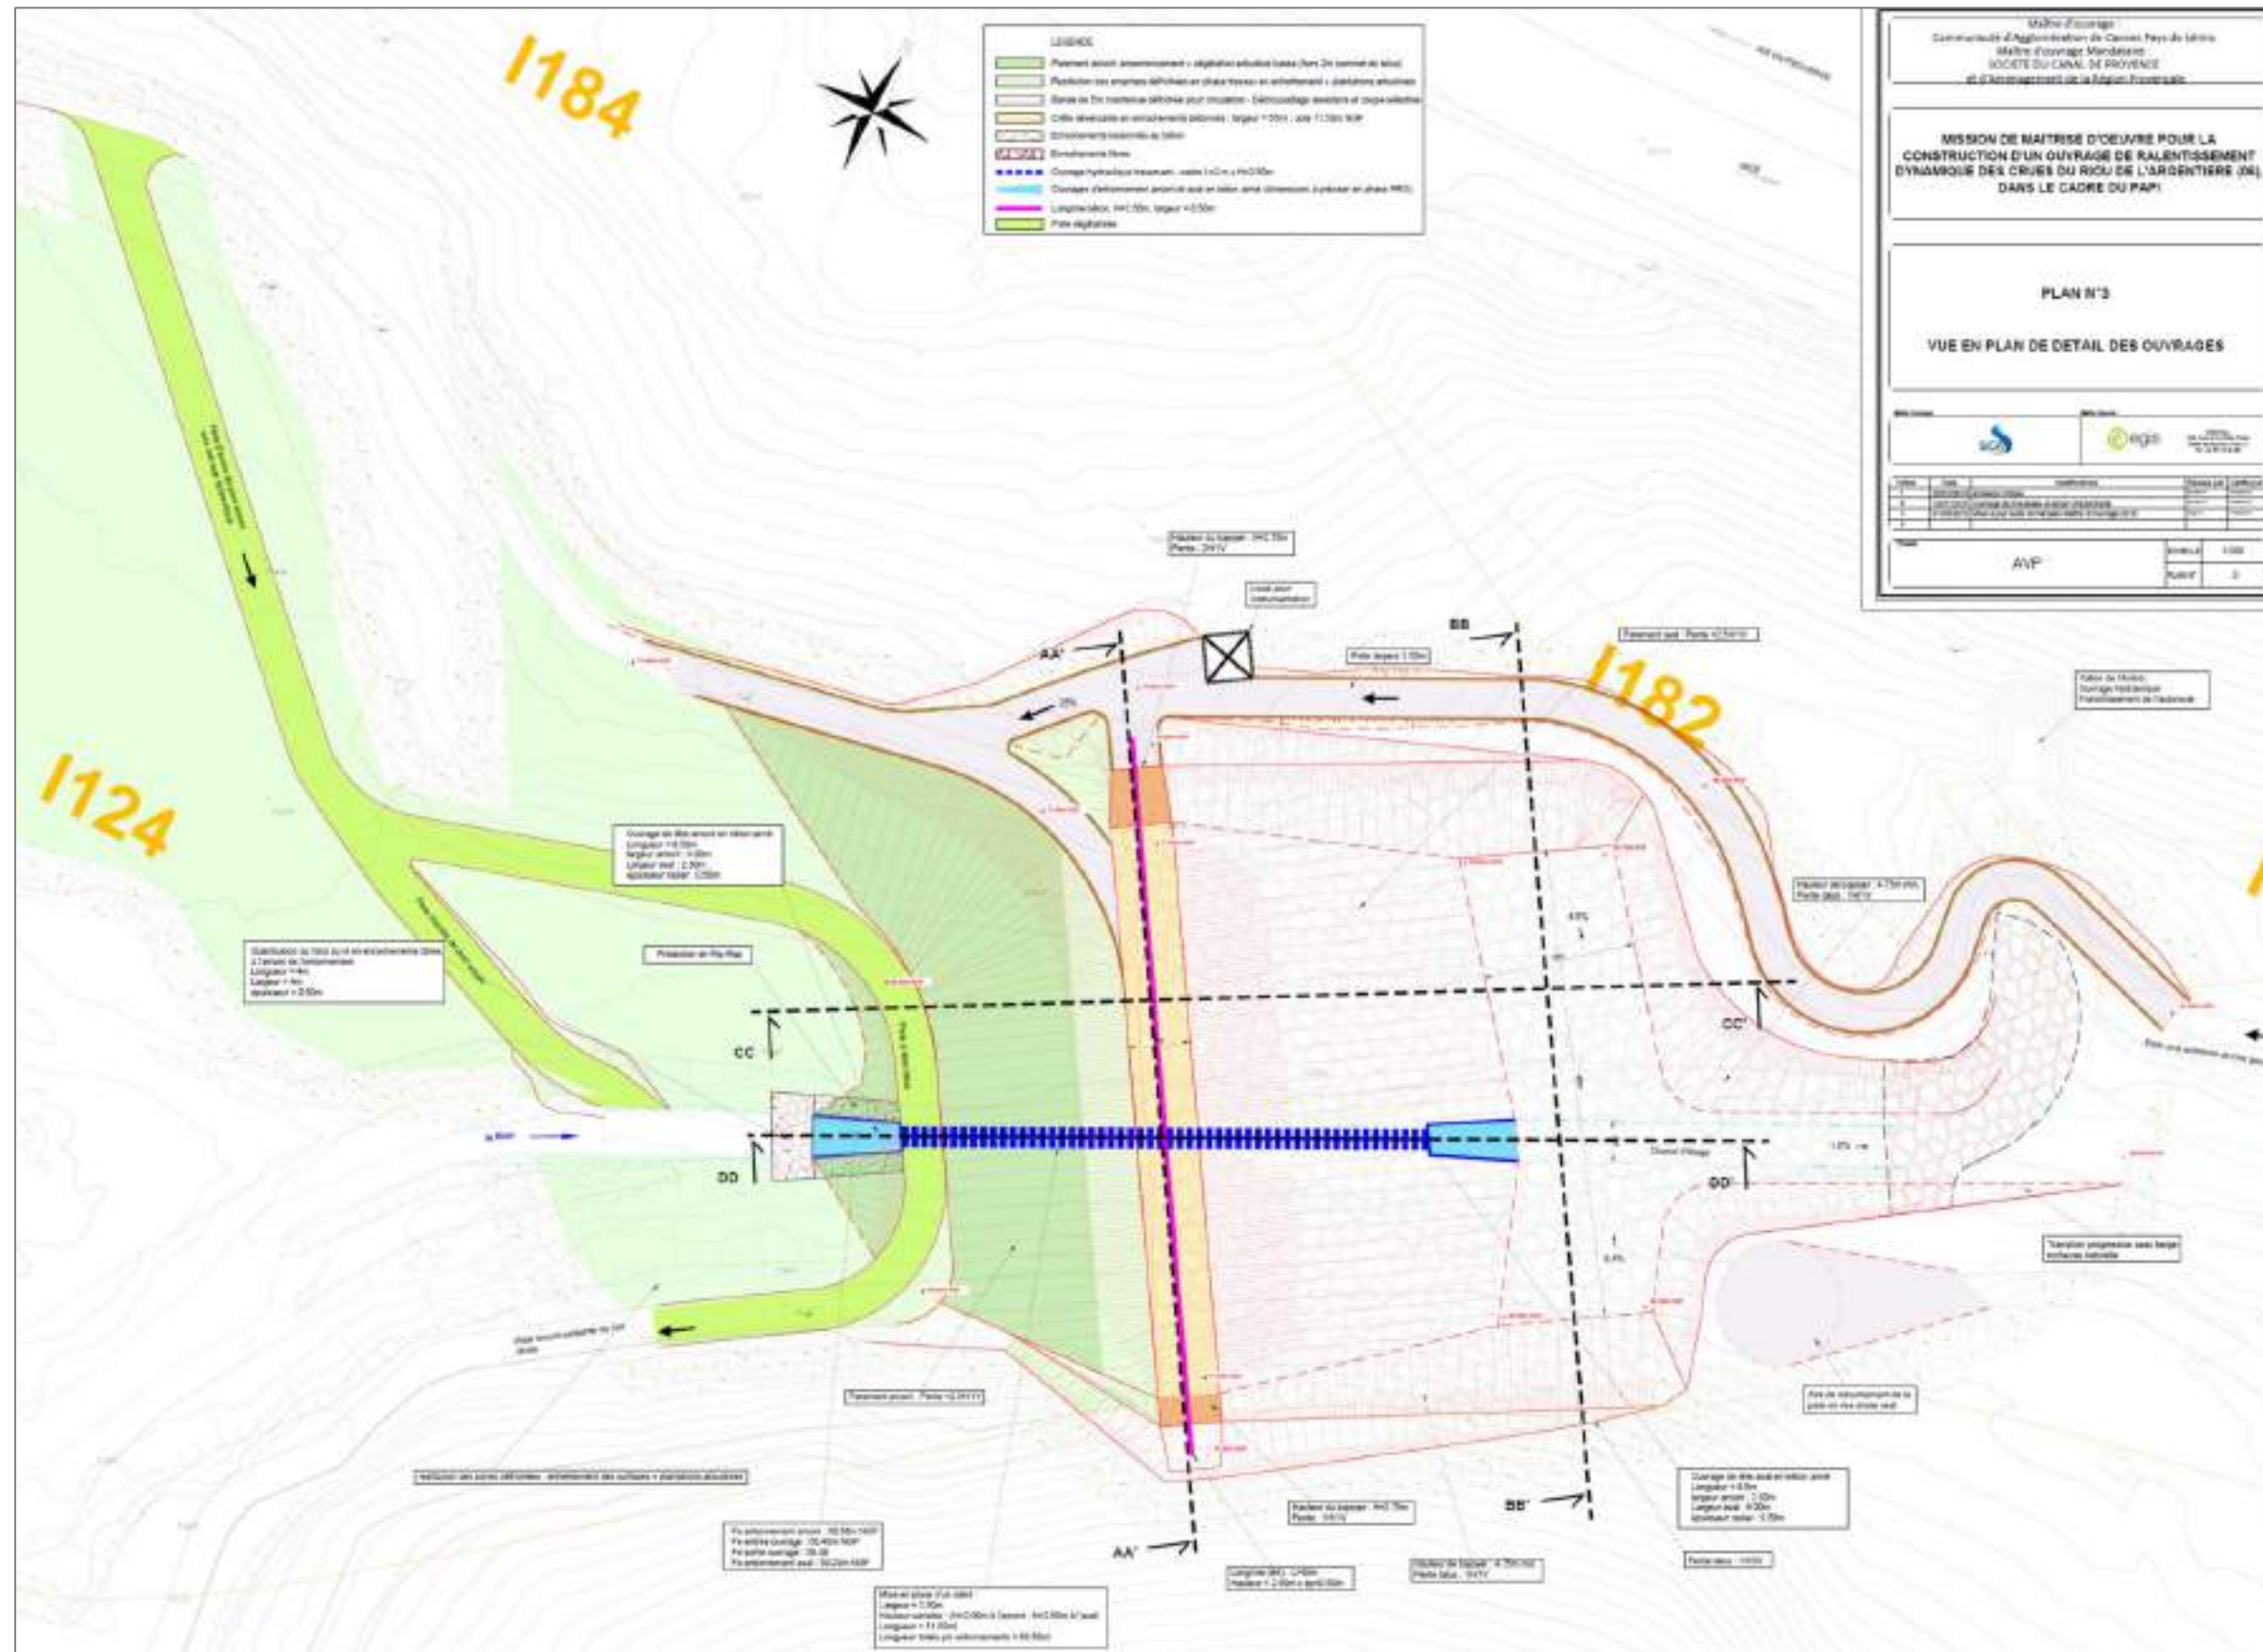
plans du projet – vue en plan de l'ouvrage projeté (AVP)
